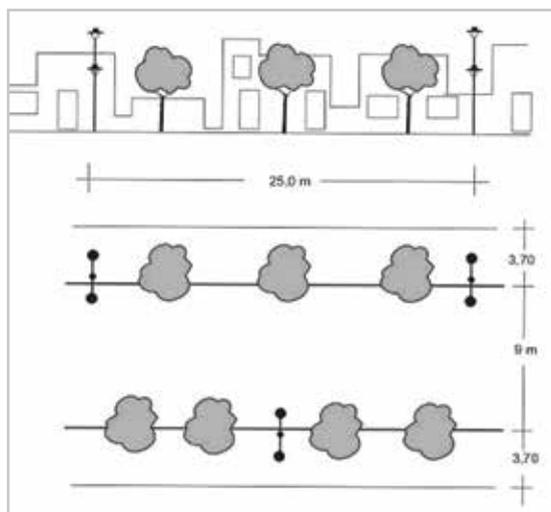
Ubicación de columnas en sectores con vegetación.
